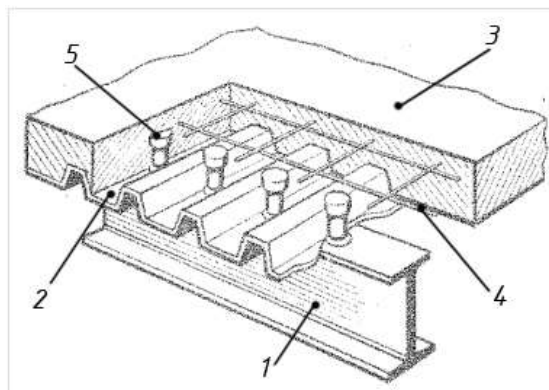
Монолітне залізобетонне перекриття за системою «VIP»
